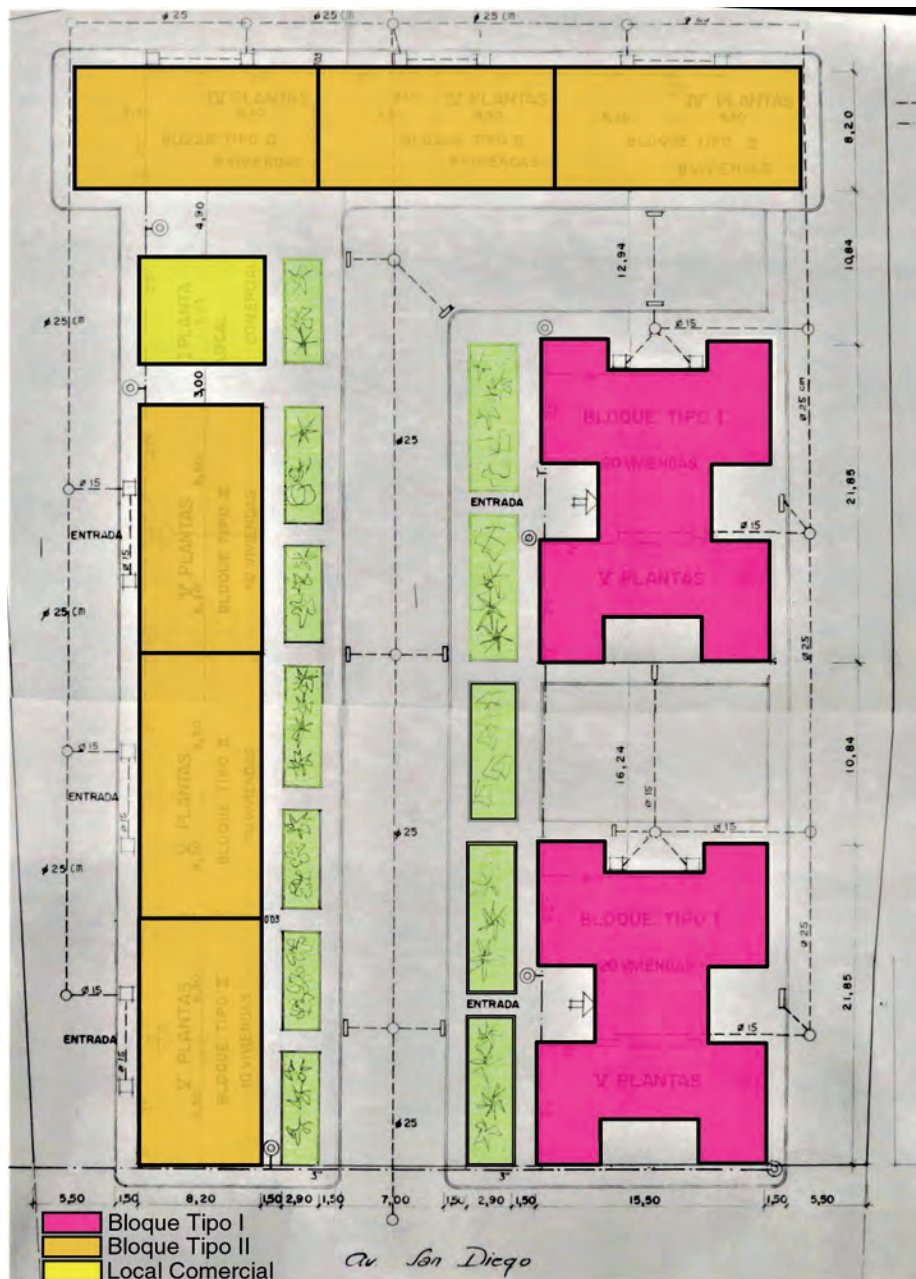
Plano general de ordenación urbana del Grupo de 94 viviendas Santa María del Alcázar con la disposición de los bloques, zonas verdes y trazado viario (A.M.L., adaptación).
